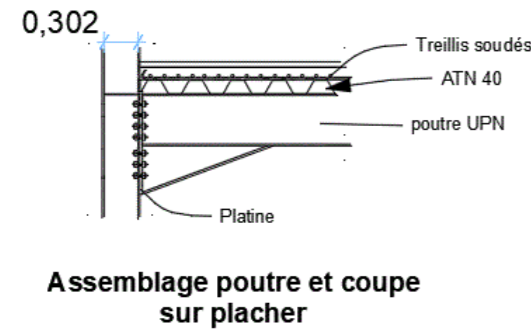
assemblage poutre et coupe sur planchers. Source : auteurs2021.
